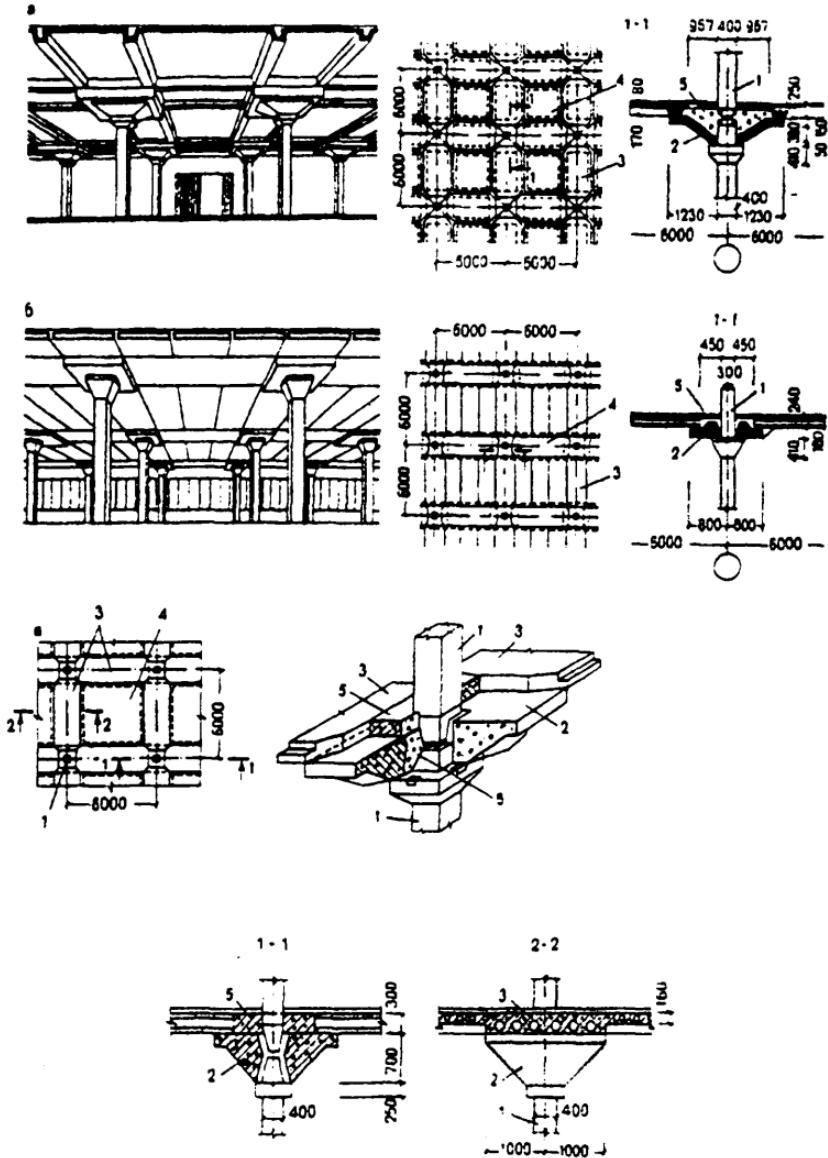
Конструкции безбалочных междуэтажных перекрытий:
